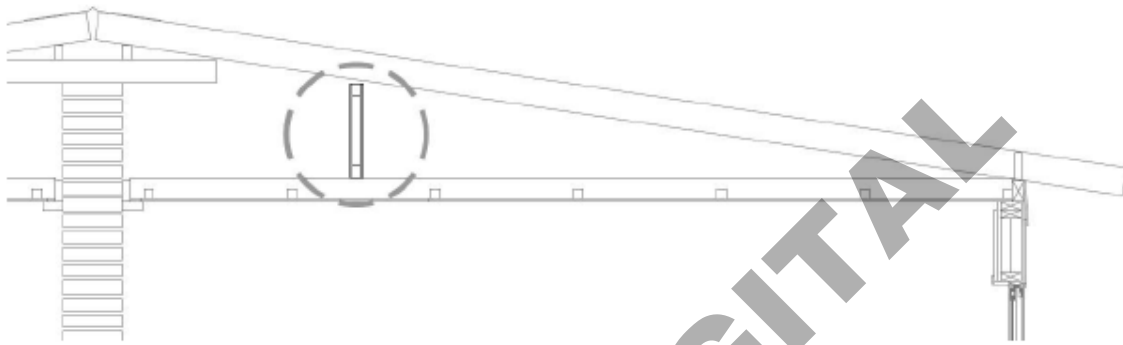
Ubicación Viga cajón, corte transversal tipología una planta
